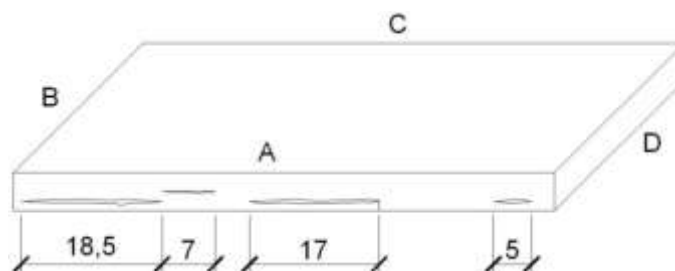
Corpo de prova 1 – P136, depois do teste de carga.
